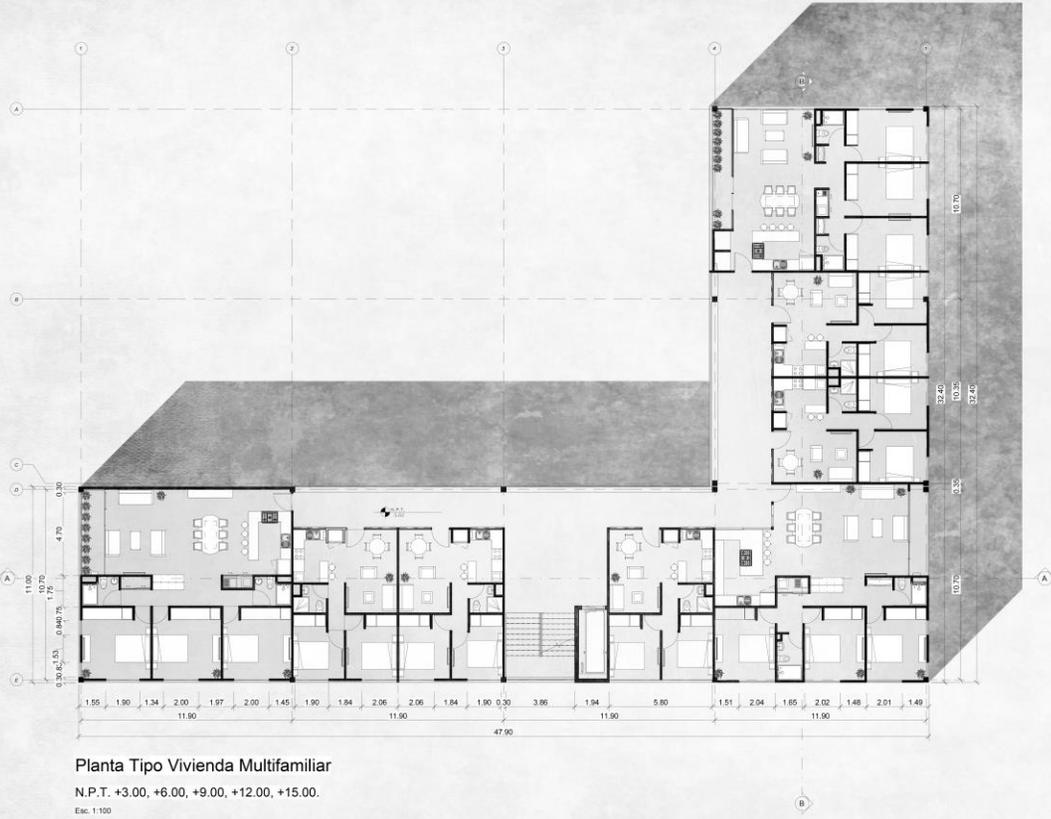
Planta Tipo vivienda Multifamiliar. Elaboración propia. 2022
